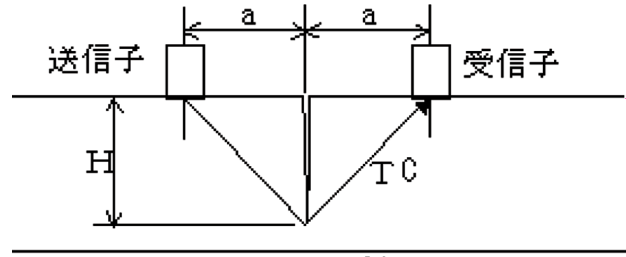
2 探触子法によるひび割れ深さ測定概要図
